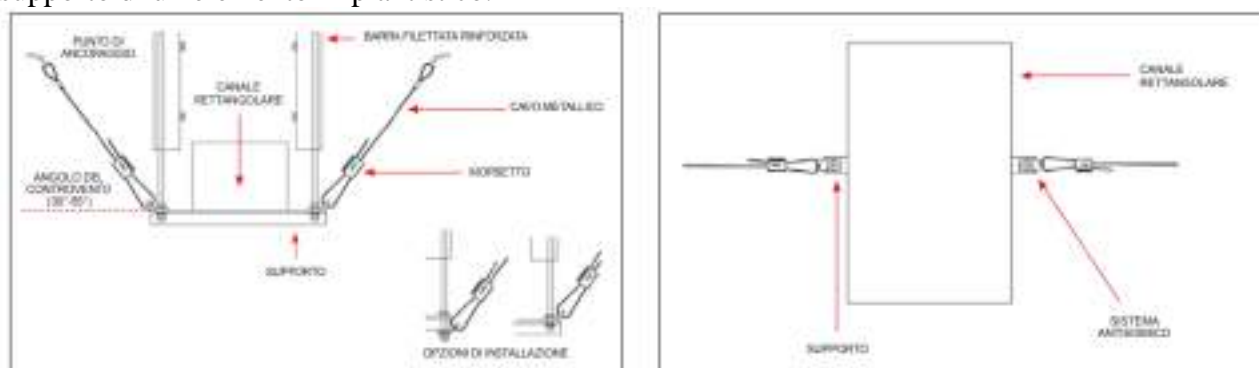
Controvento trasversale – vista trasversale e planimetrica
